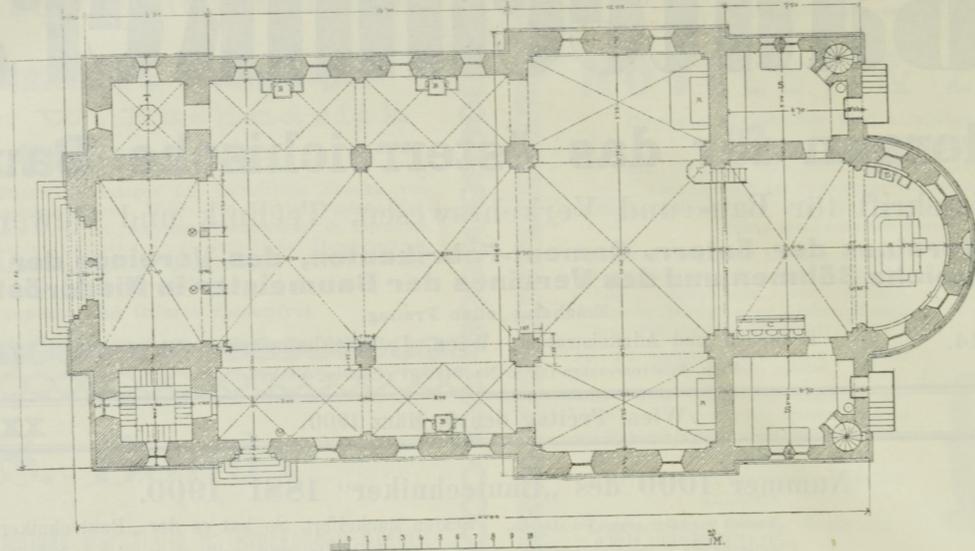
Grundriss vom Erdgeschoss.
